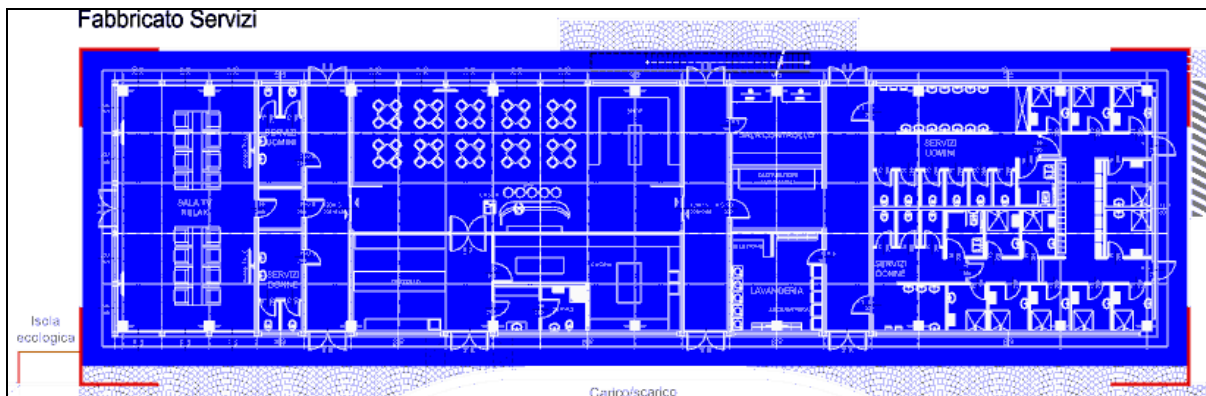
Planimetria area Fabbricato Servizi
